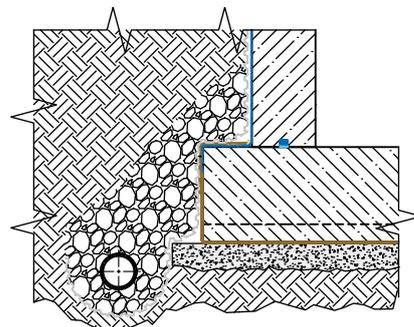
Узел – гидроизоляция фундамента при новом строительстве (подробнее на стр. 37)
